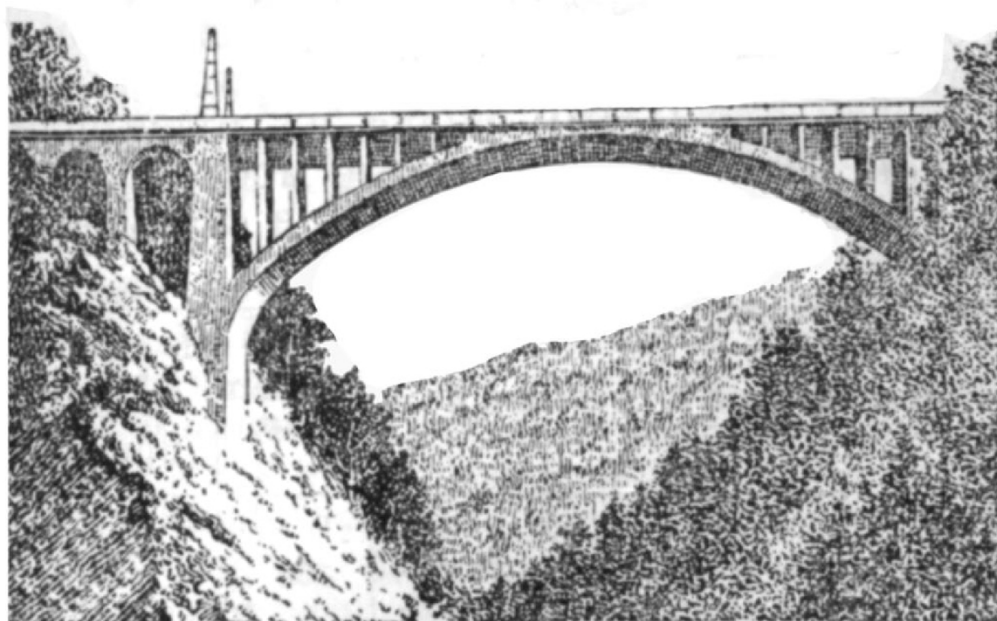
Мост с железобетонными арочными перекрытиями под ездовым полотном
